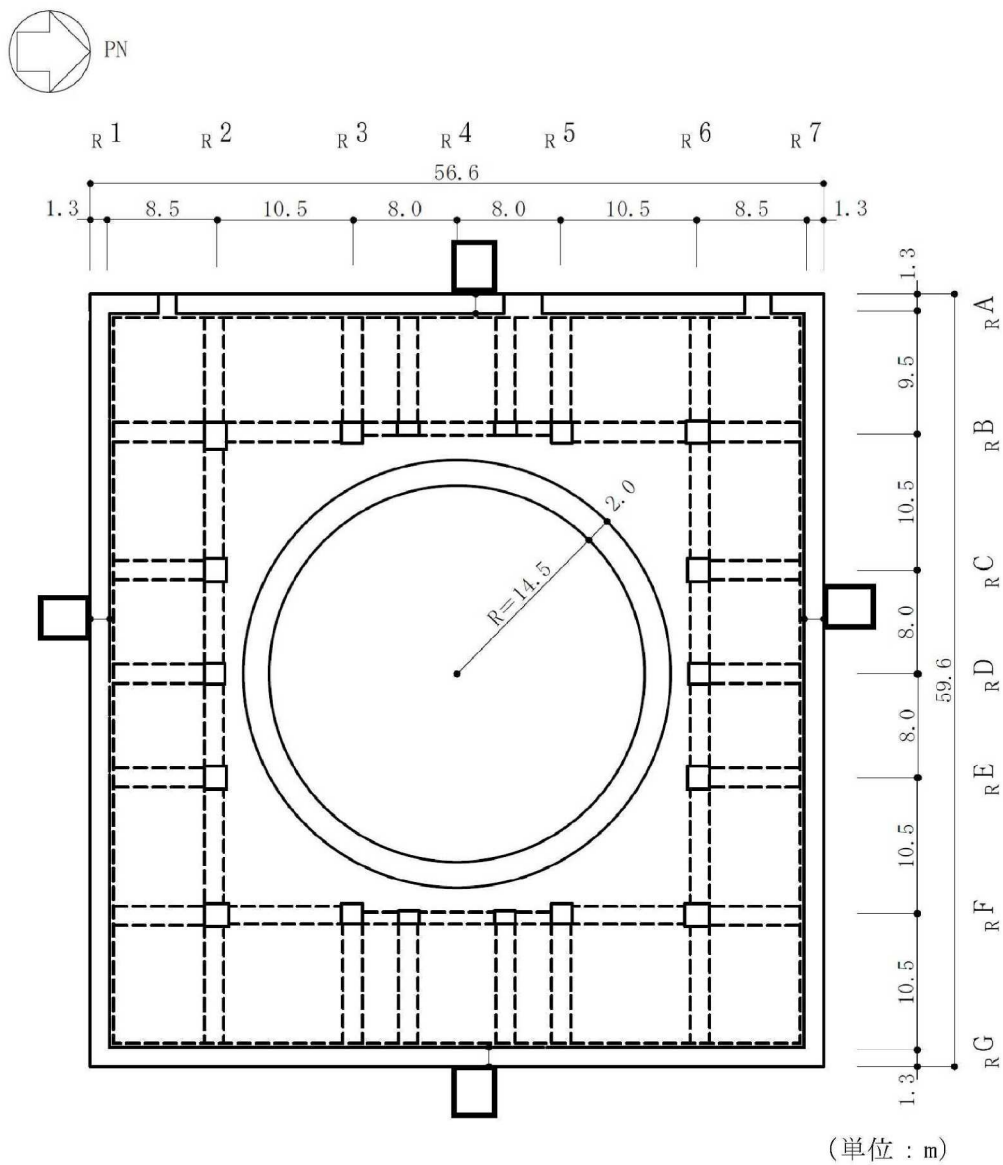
原子炉建屋の概略平面図 (B1F, T.M.S.L. 4.8m) (3/9)
